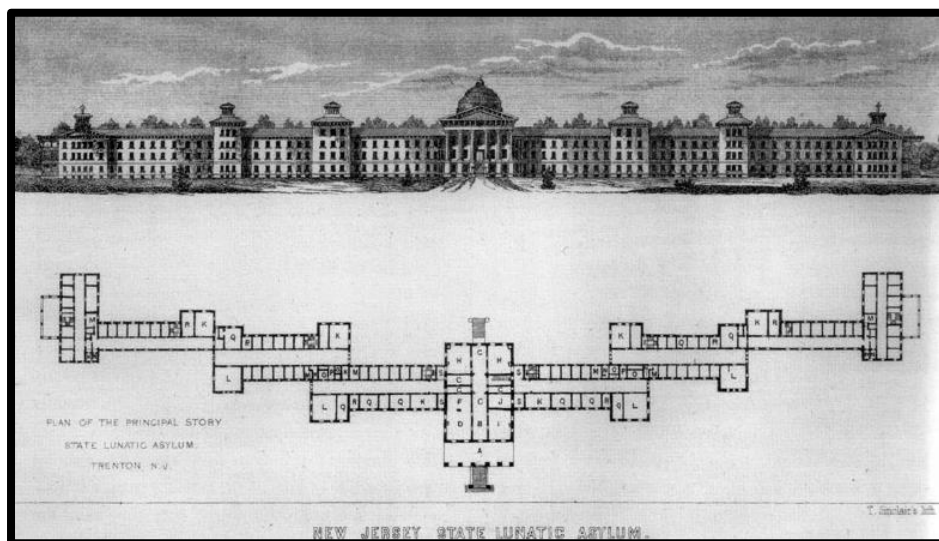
Hospital Psiquiátrico bajo el plan Kirkbride
